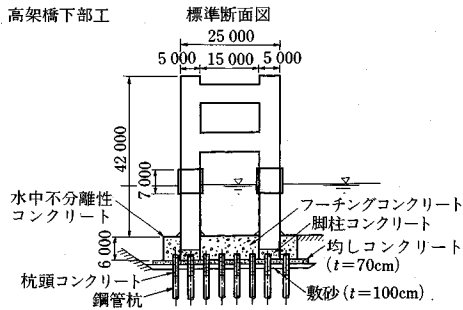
水中不分離性コンクリートを使用した海中高架橋の施工
